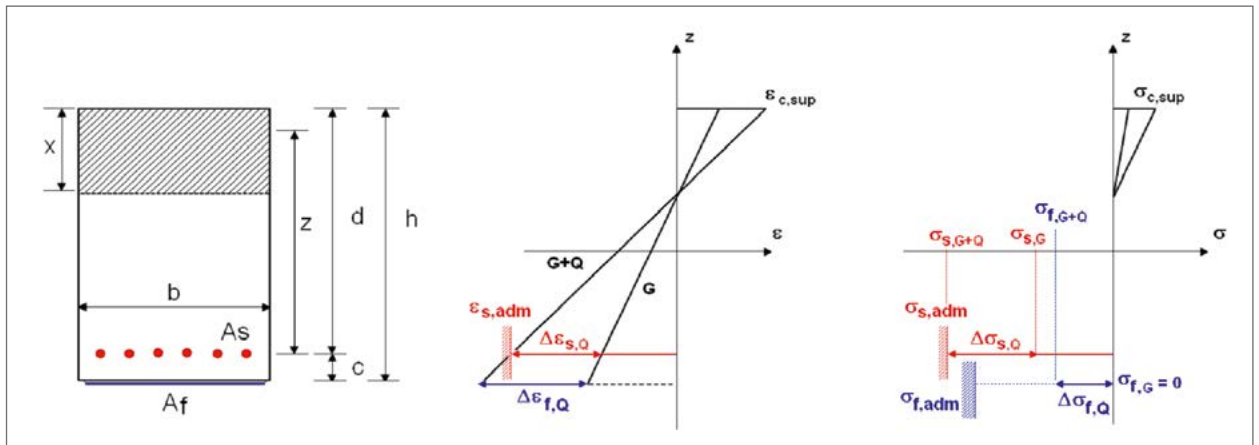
Poutre en béton armé sollicitée en flexion simple
